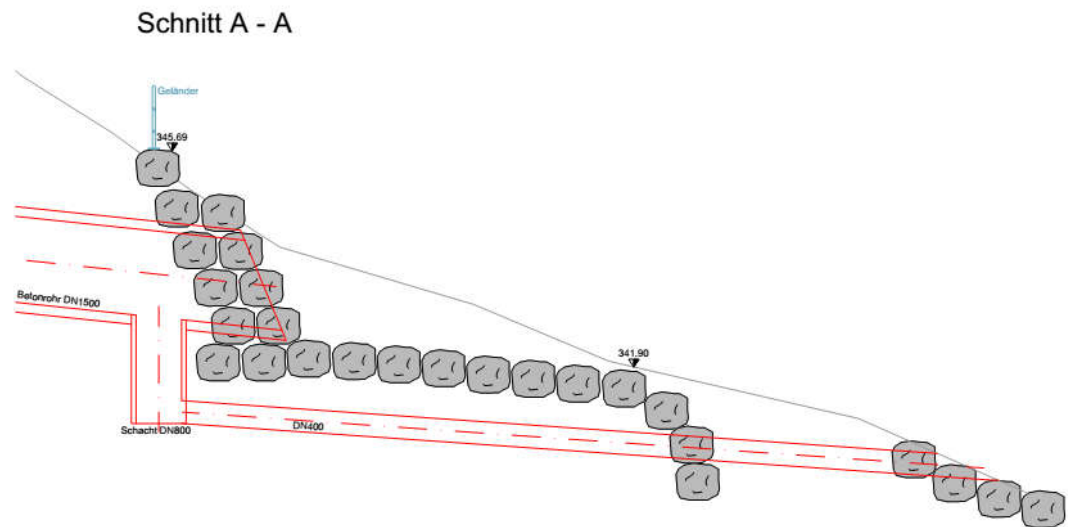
Auszug Plan 104 Einleitbauwerk
